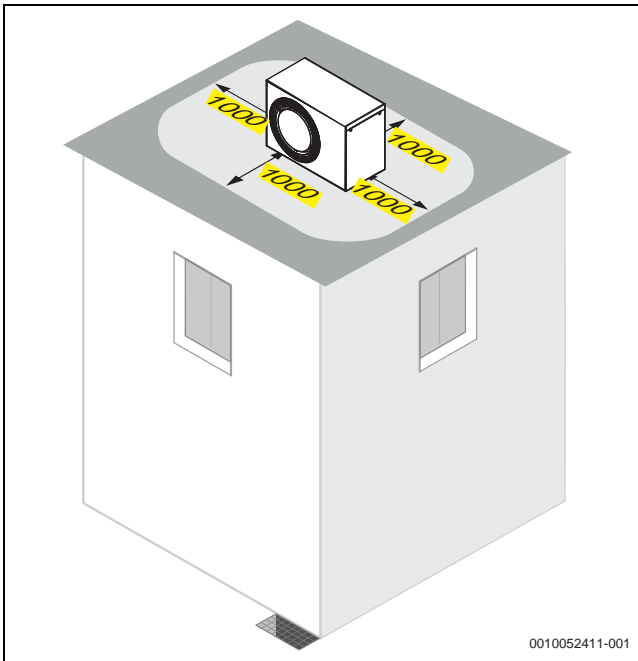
Empfohlener Abstand zwischen der Wärmepumpe und umgebenden festen Objekten bei Installation auf dem Dach (Maße in mm)
